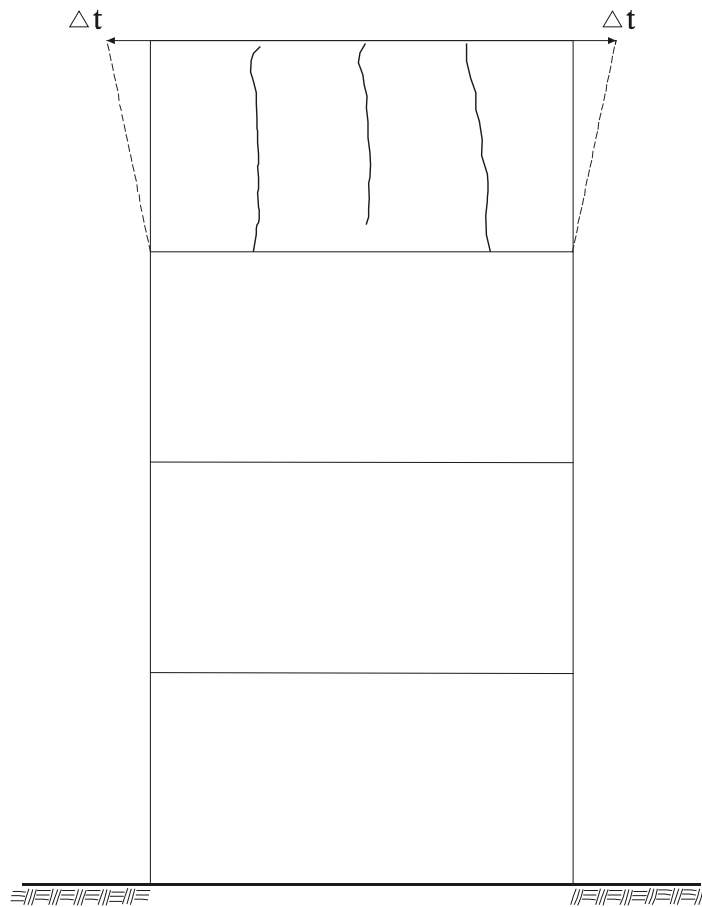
Fissuras verticais em alvenarias junto à cobertura, provocadas pela dilatação térmica da laje de cobertura que traciona as paredes.
